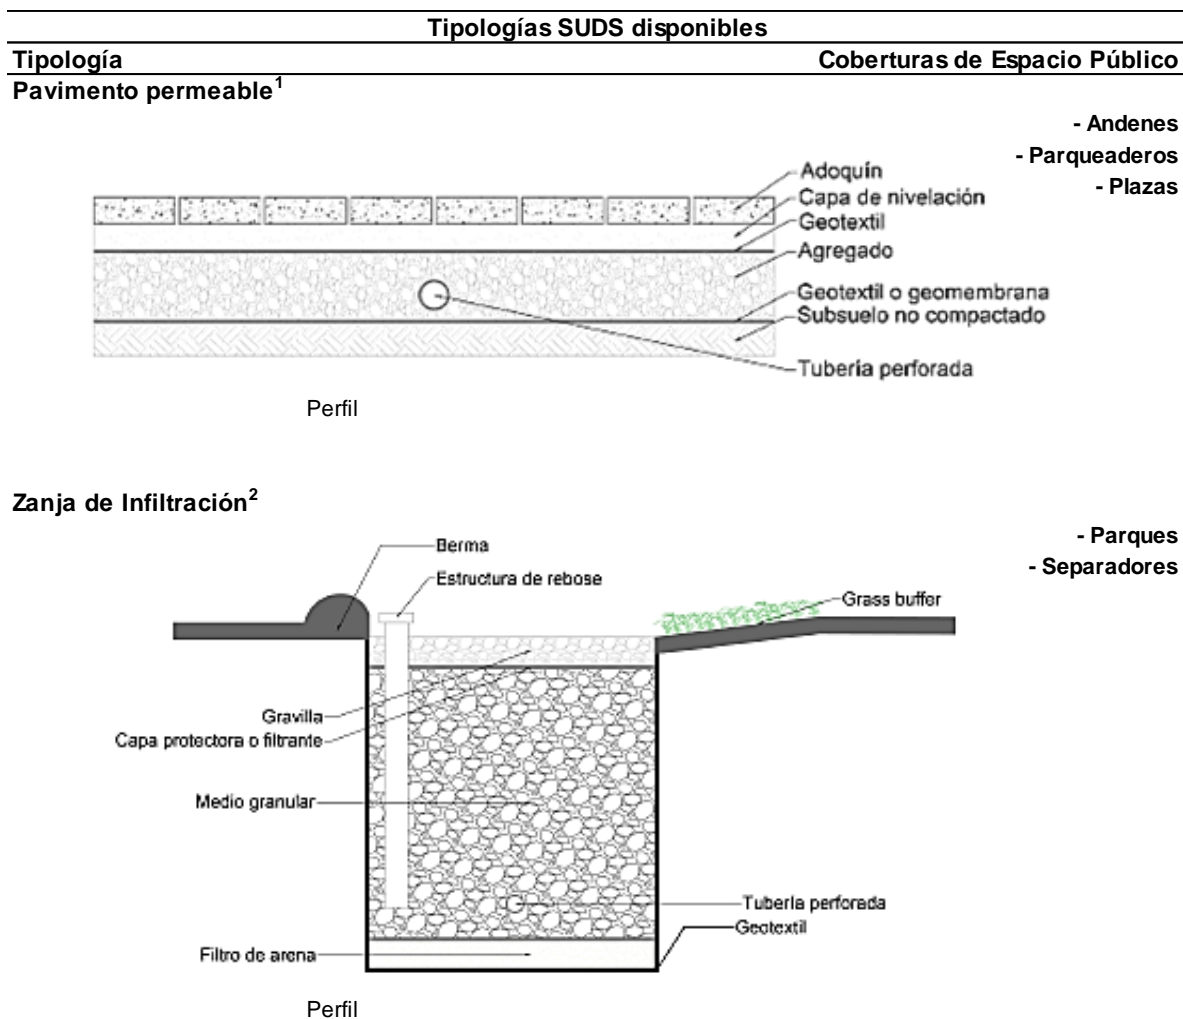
Tipologías SUDS disponibles (Pavimento permeable, zanja de infiltración)
